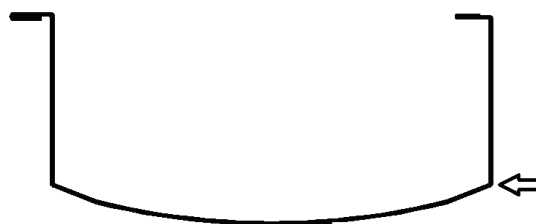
Сечения/расчетная схема для определения предельно допустимых нагрузок на свод
